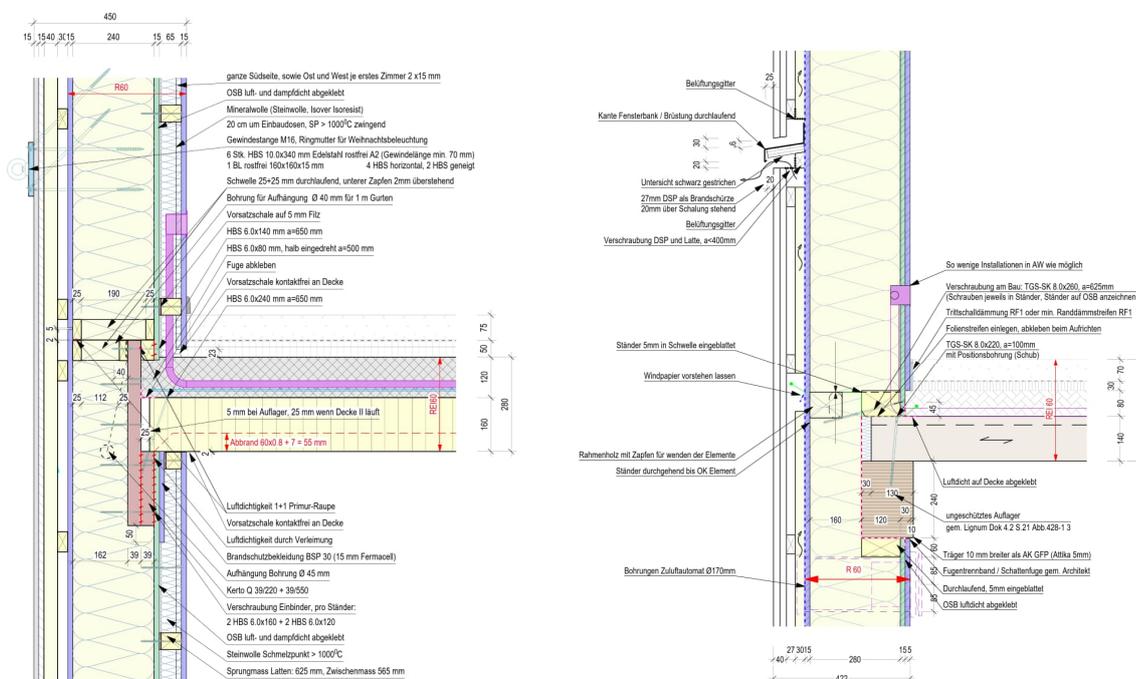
Aussenwandaufbauten und Anschlussdetails Holzrahmenbauweise (links: mit Vorsatzschale, Furnierschichtholzeinbinder; rechts: ohne Vorsatzschale, Brettschichtholzeinbinder)
